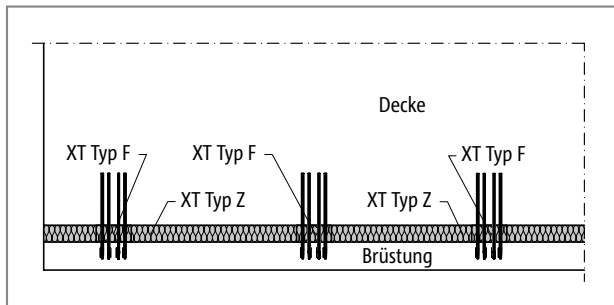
Schöck Isokorb® XT Typ F, Z: Frontal angeschlossene Brüstung
